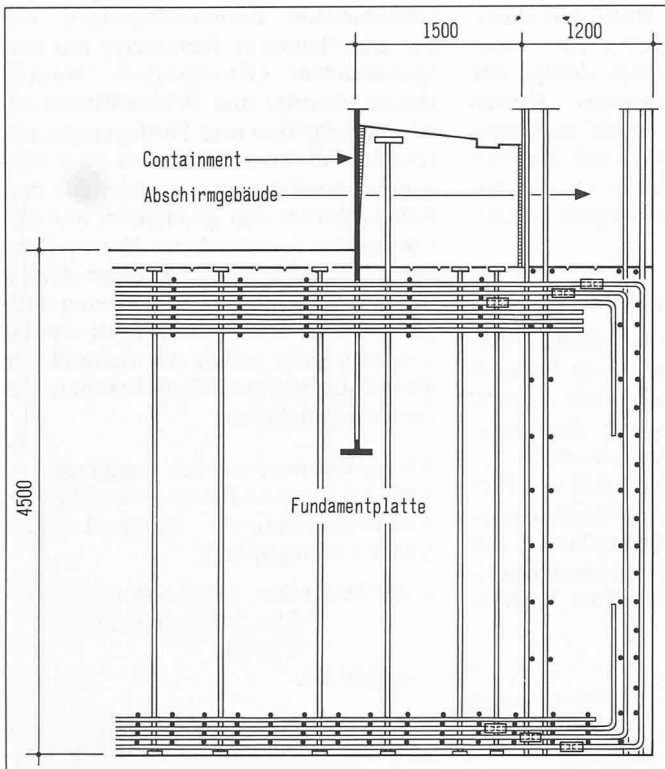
Detail des Bewehrungsanschlusses zwischen Fundamentplatte und Abschirmgebäude des Reaktorgebäudes
